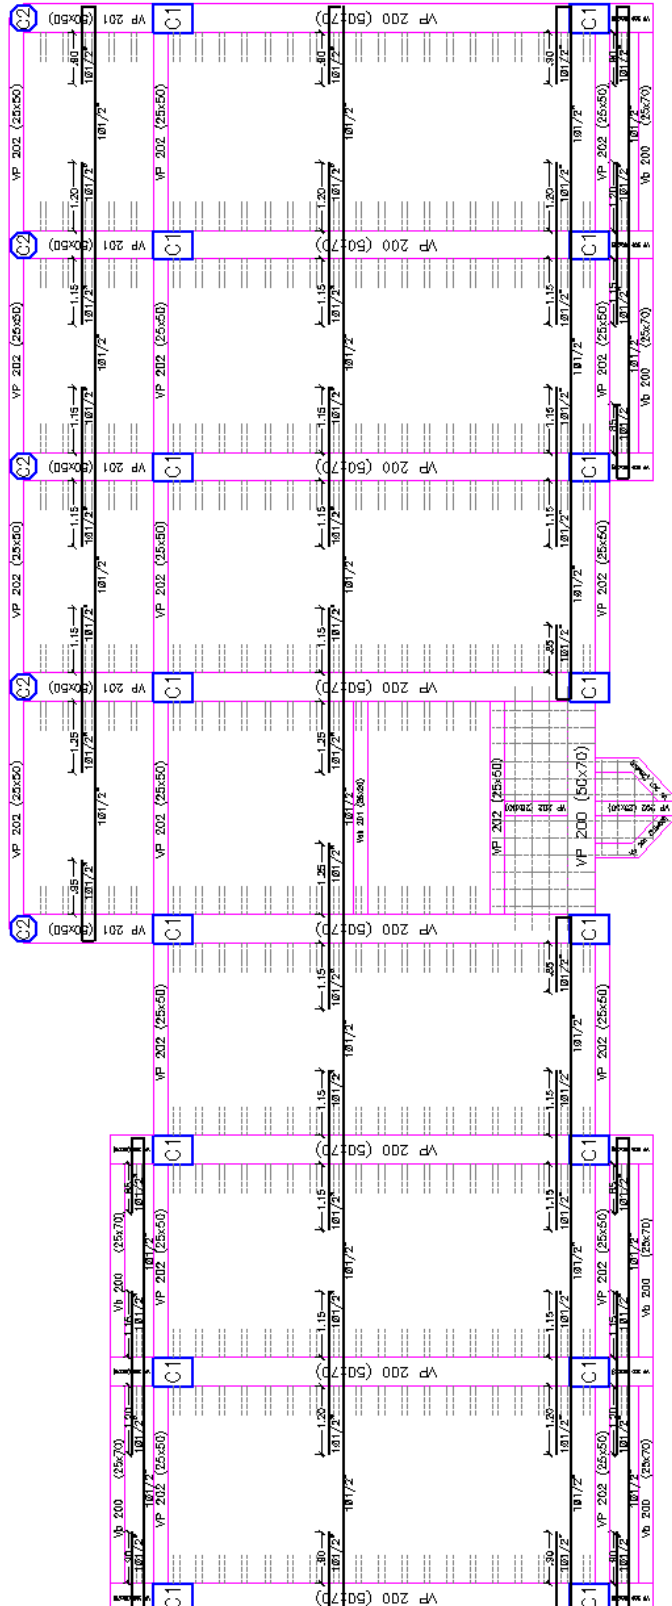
Planta, aligerado 2, NTNT: +6.90.
